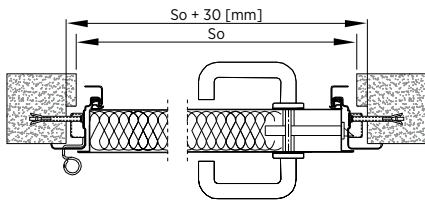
Montage mural d'un bloc-porte à un battant avec bâti angulaire - coupe horizontale
